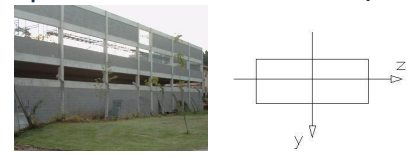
(a) - Estrutura em concreto armado (b) - seção esquemática dos pilares.
